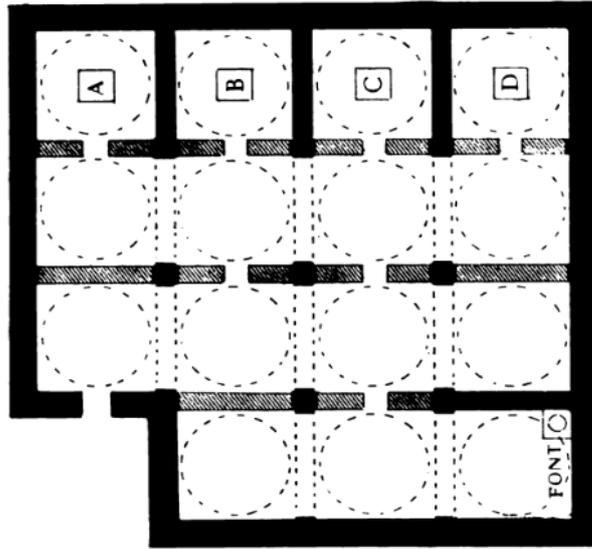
مسقط أفقي لكنيسة دير الأنبا هدرا بأسوان يوضح وجود ثلاثة هياكل مستطيلة
